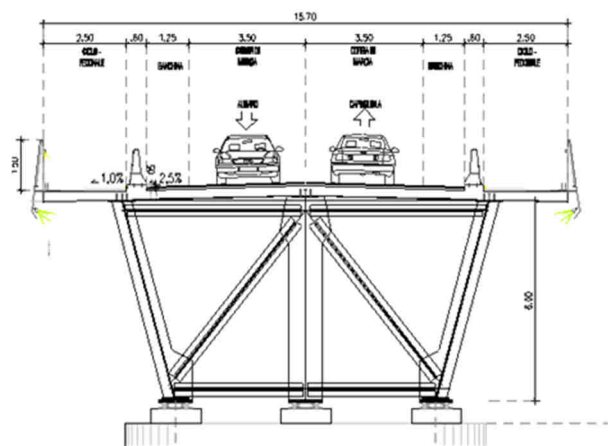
Nuovo ponte sul Magra. Sezione di Pila.
